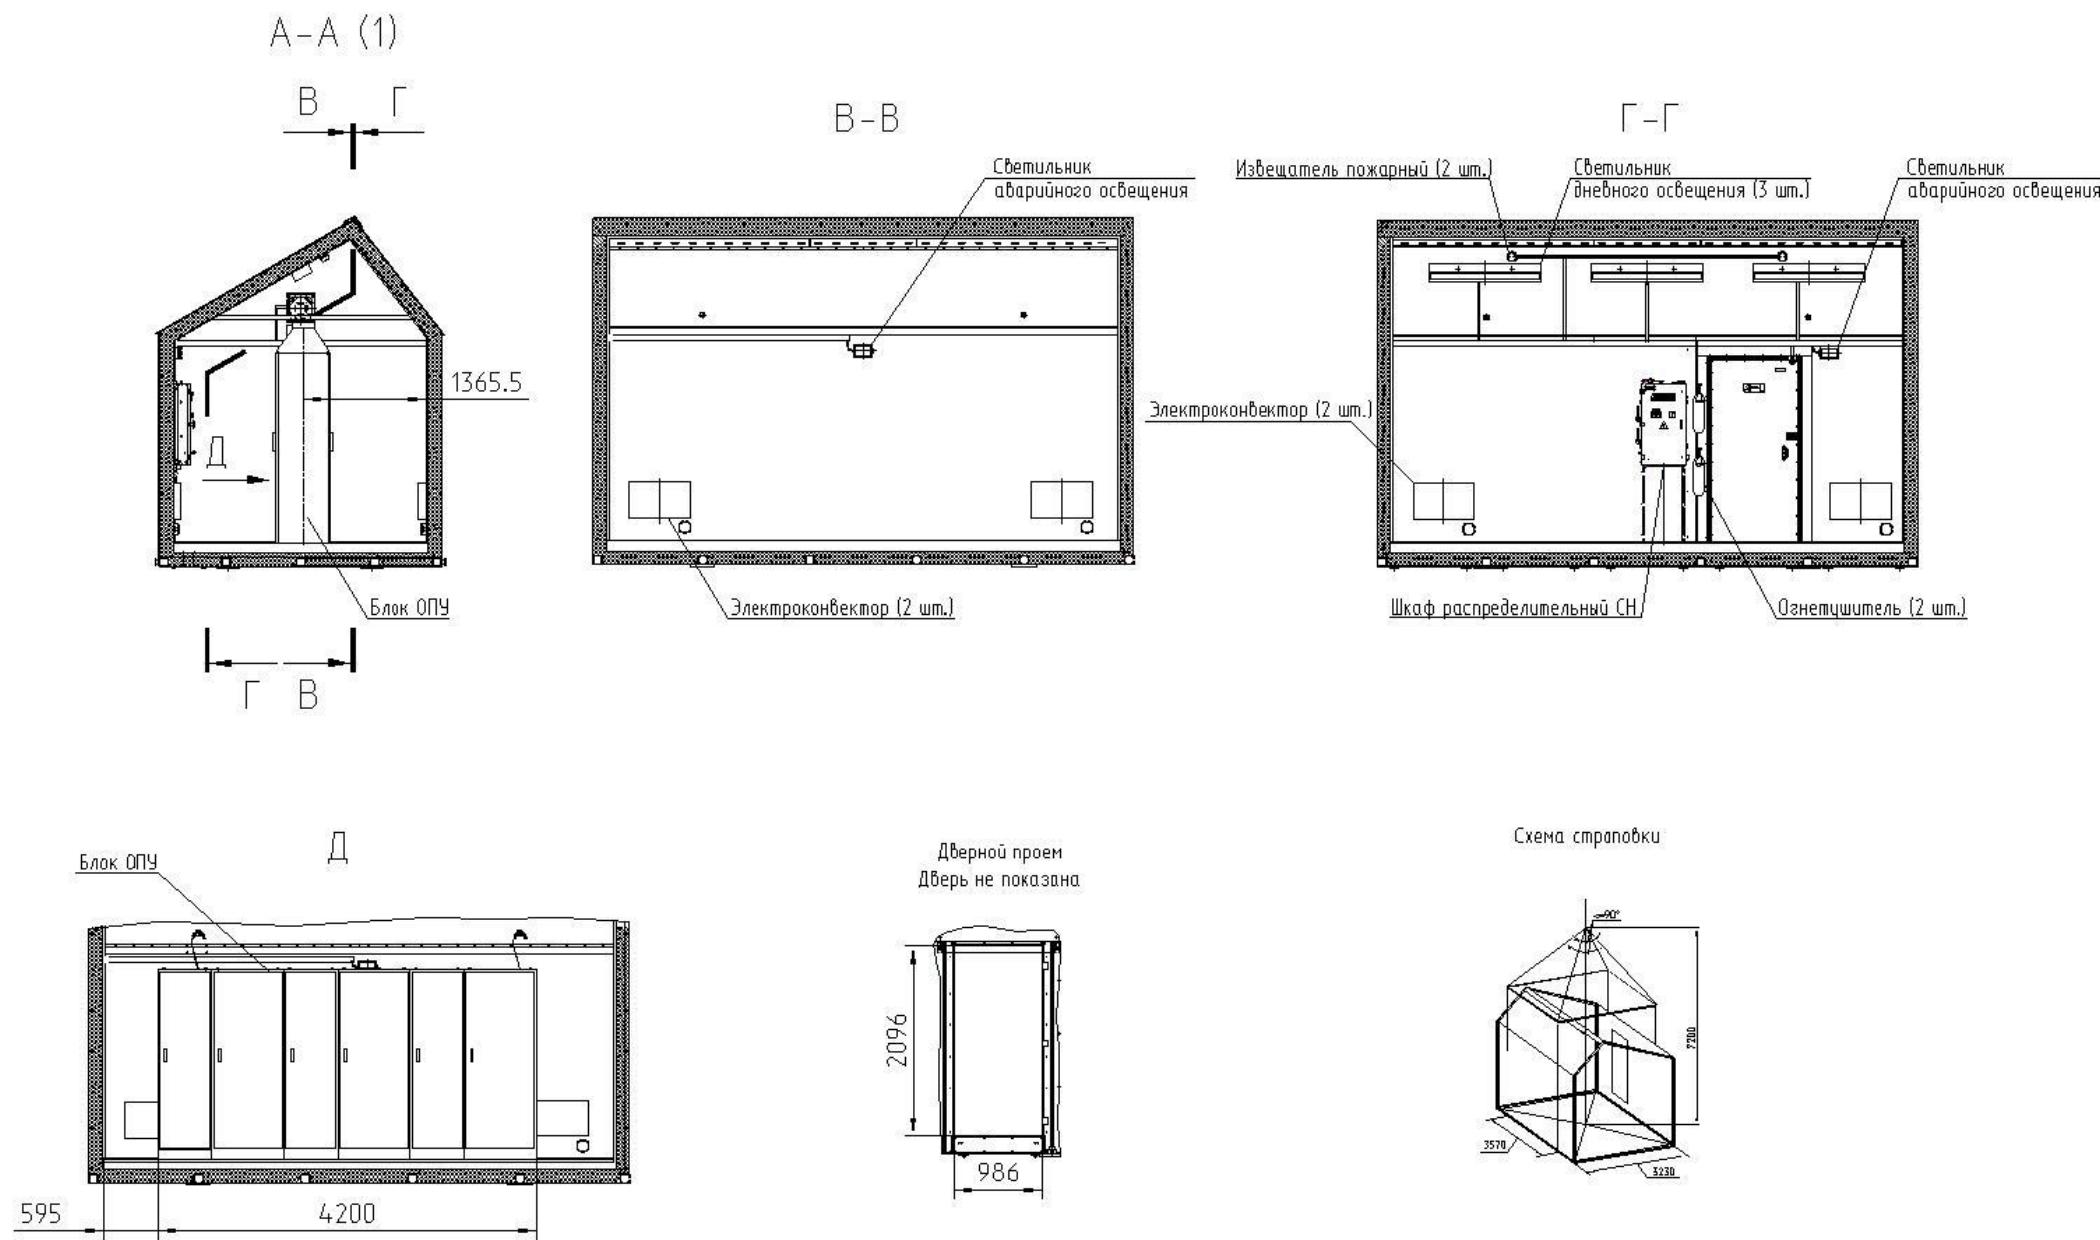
Габаритный чертеж модуля ОПУ типоразмером 6 м
